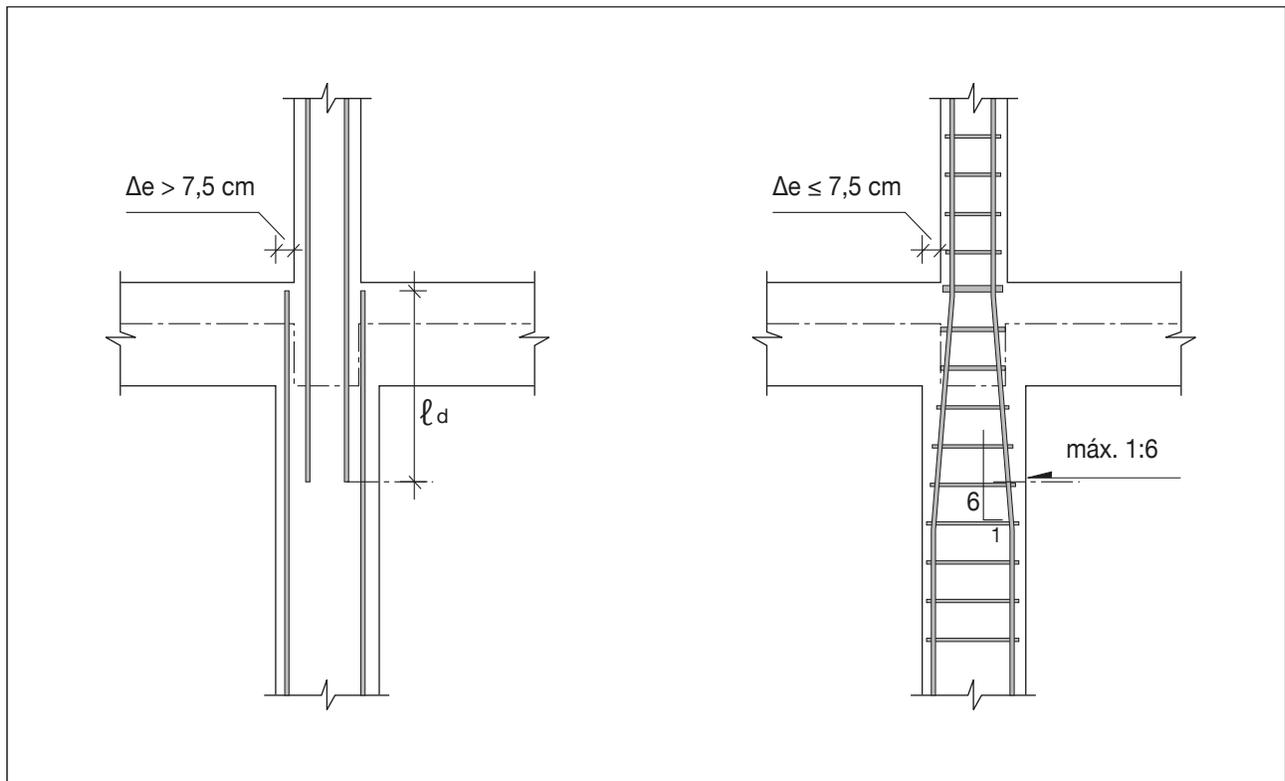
Ejemplo de Barras Longitudinales en una columna por cambio de sección.
